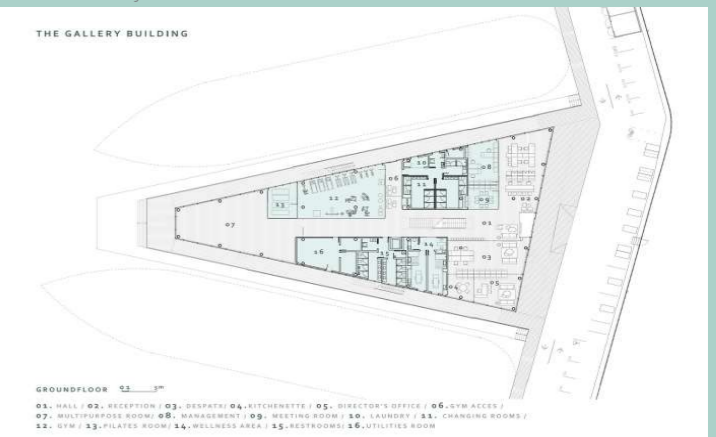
Planta Baixa da edificação nova da Marina Port Vell.
